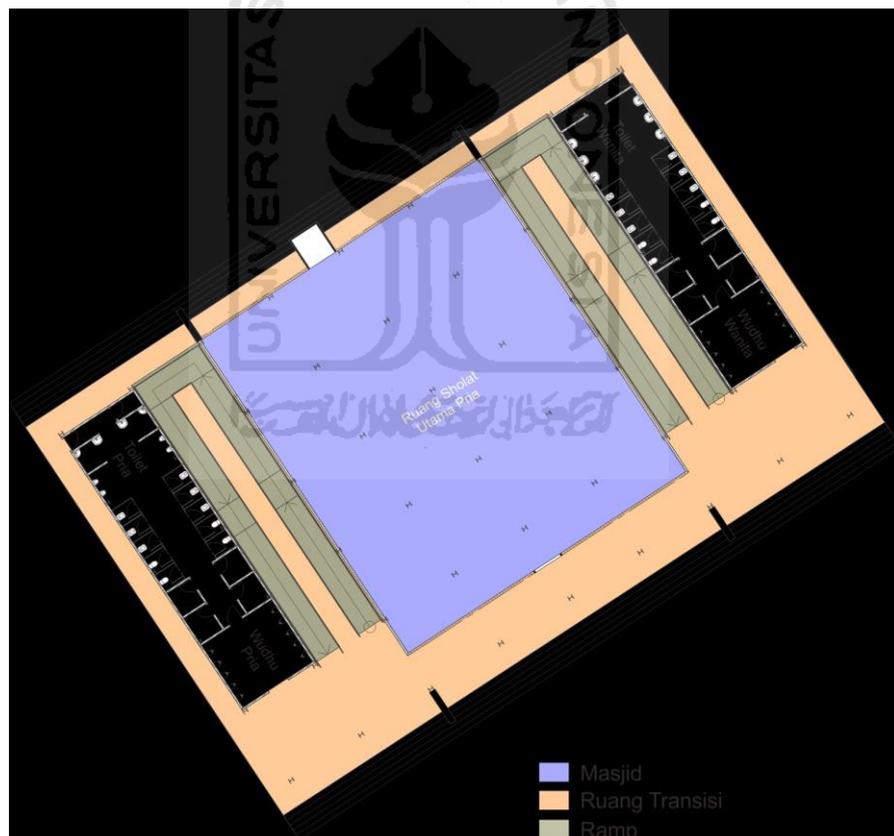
Denah Masjid dan Rest Area lantai 1. Sumber: Penulis
